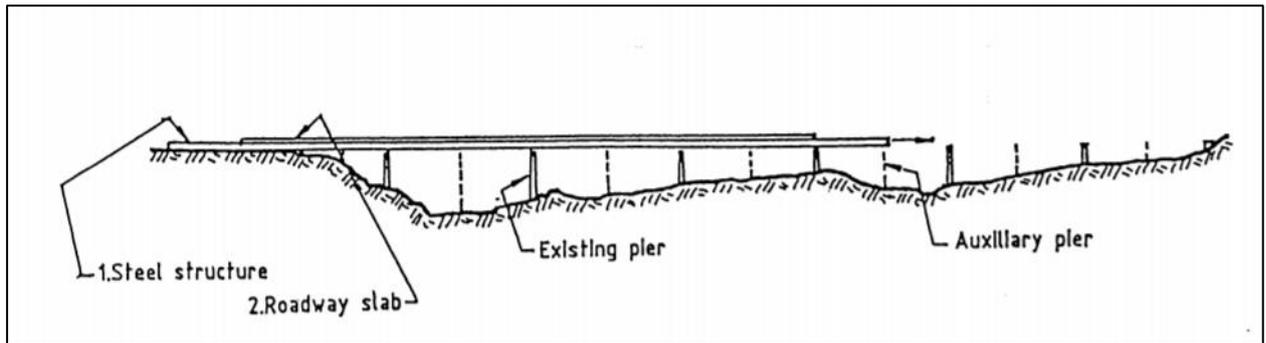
construcción estructura puente Wikau-Hablau [3]
